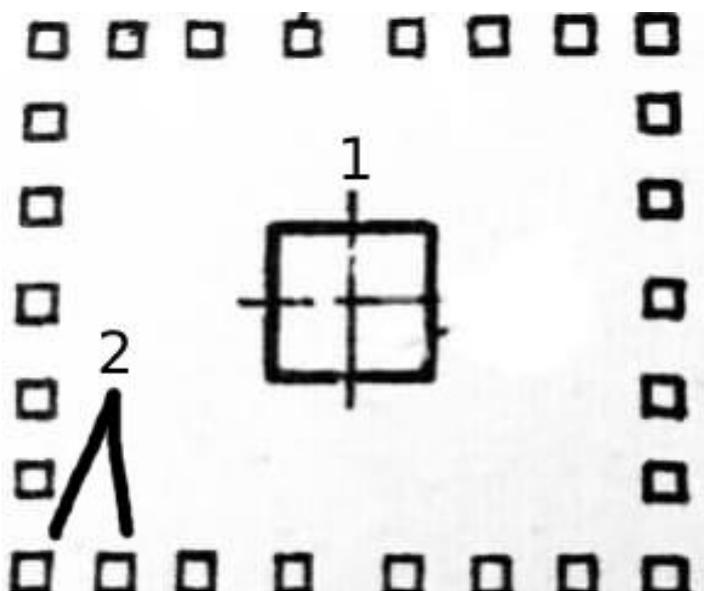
План здания с периферийной рамной системой 1-внутреннее ядро жесткости; 2-колонны по периферии плана здания
